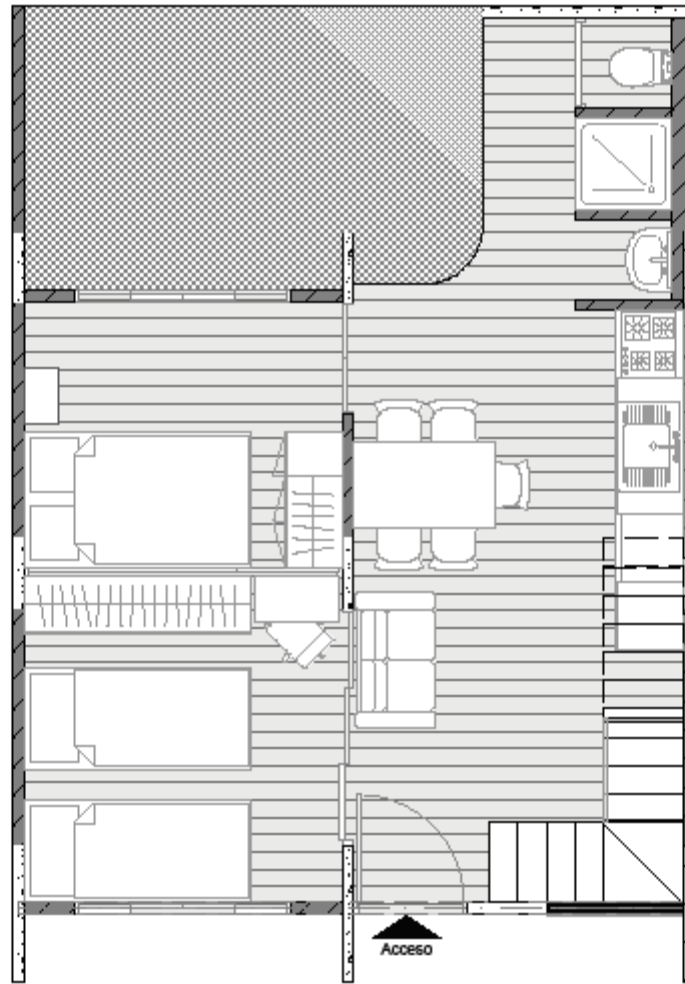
Tipo A. Planta primer piso amoblado. Esc.:1:50
